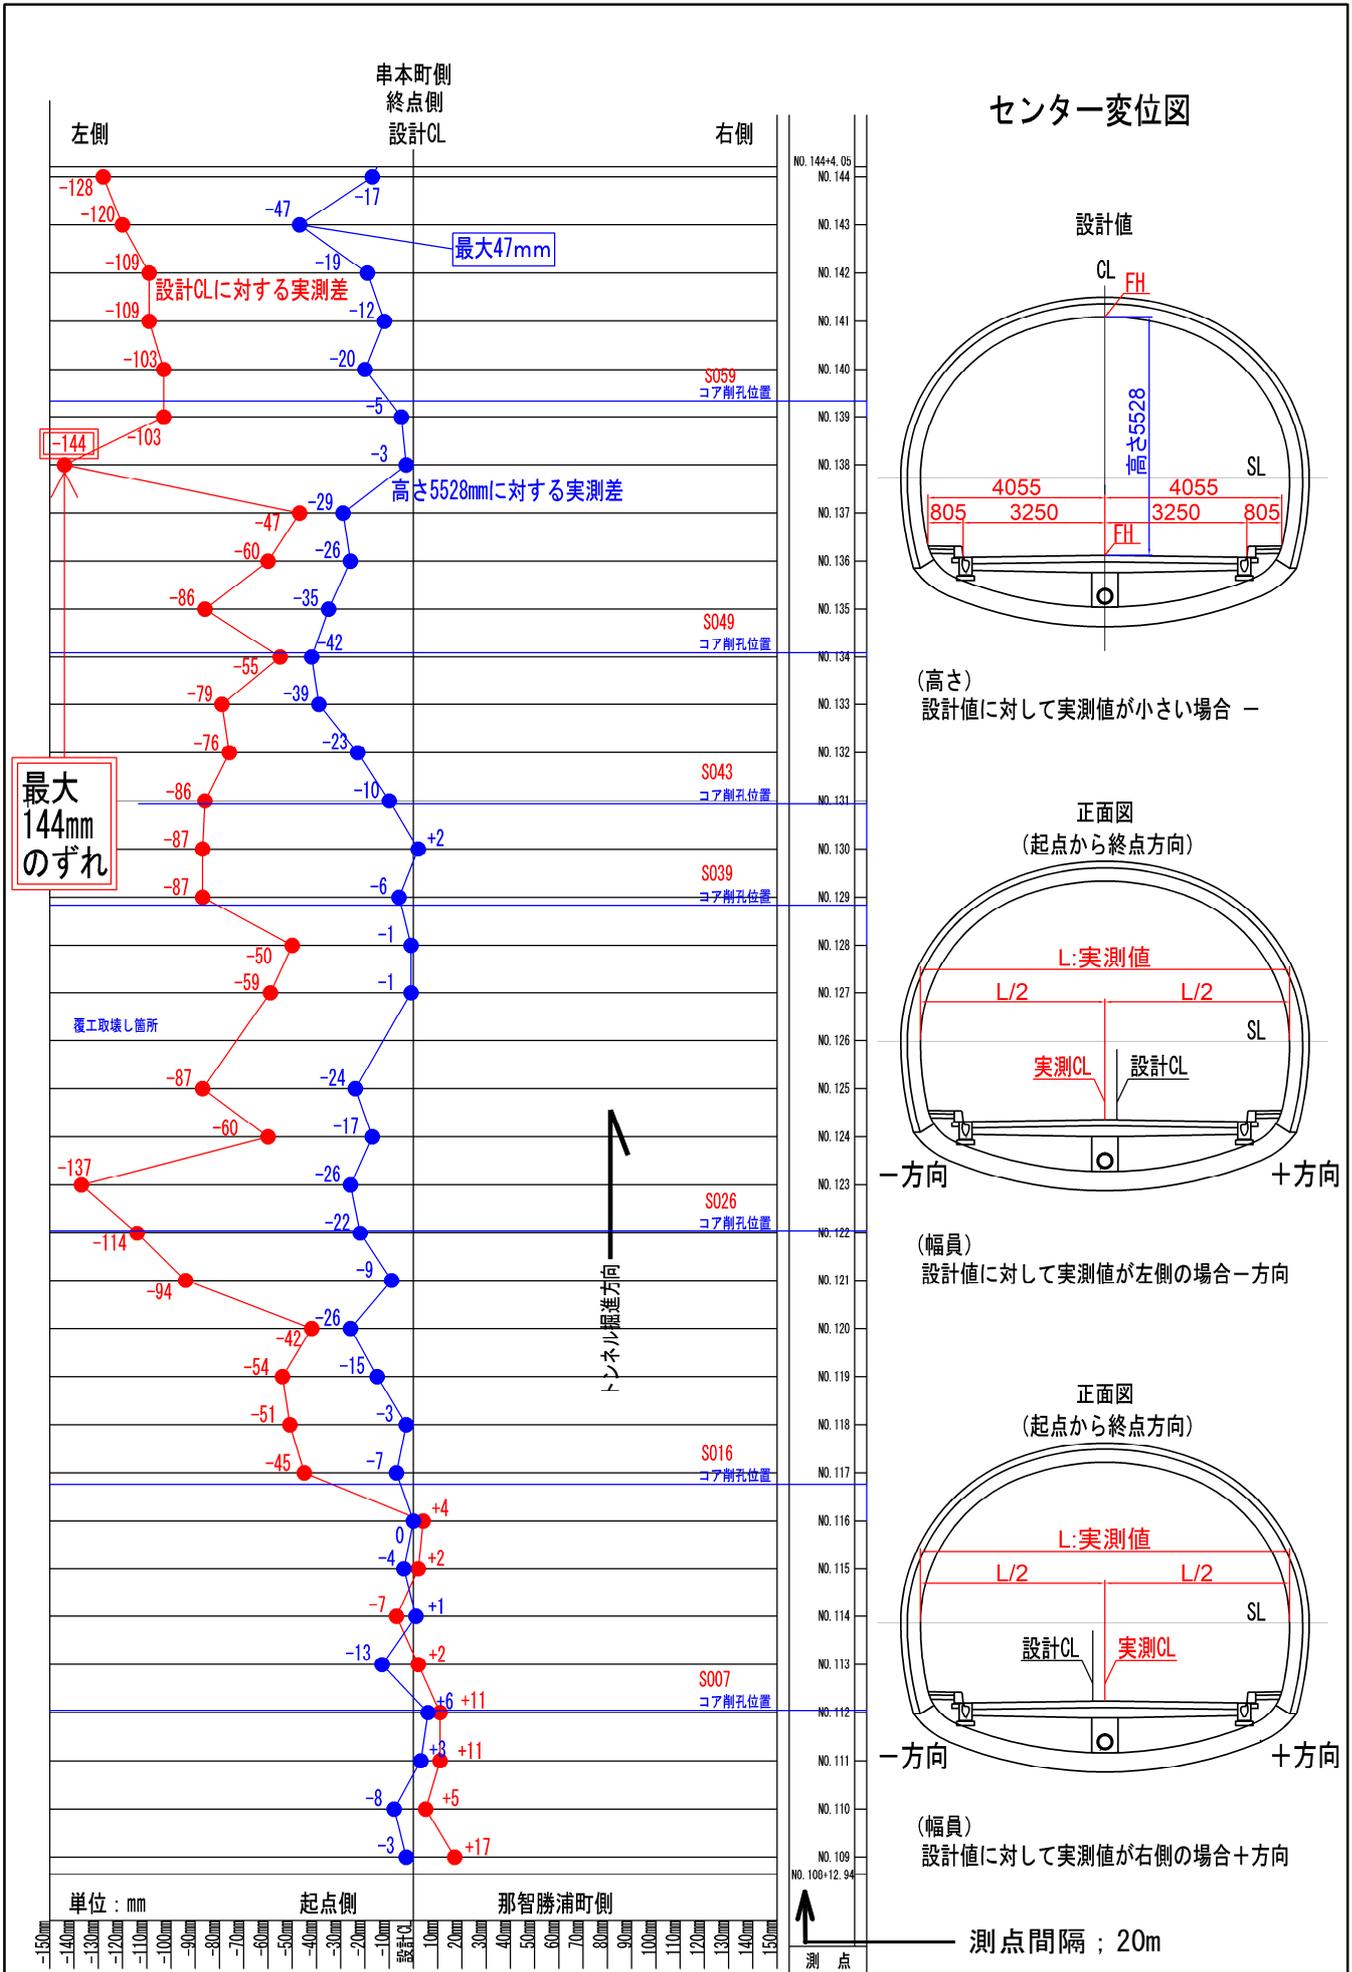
トンネル CL のズレをモデル化した断面図
